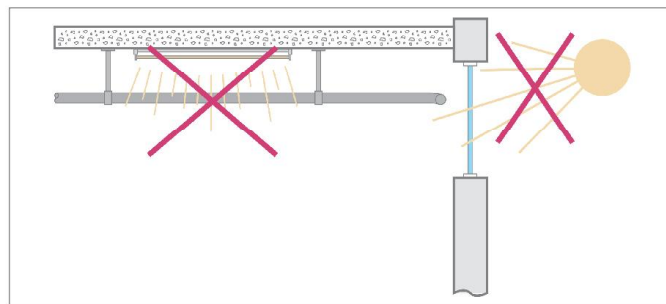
Открытая укладка в зоне воздействия ультрафиолетовых лучей в том числе внутри здания не допускается.
